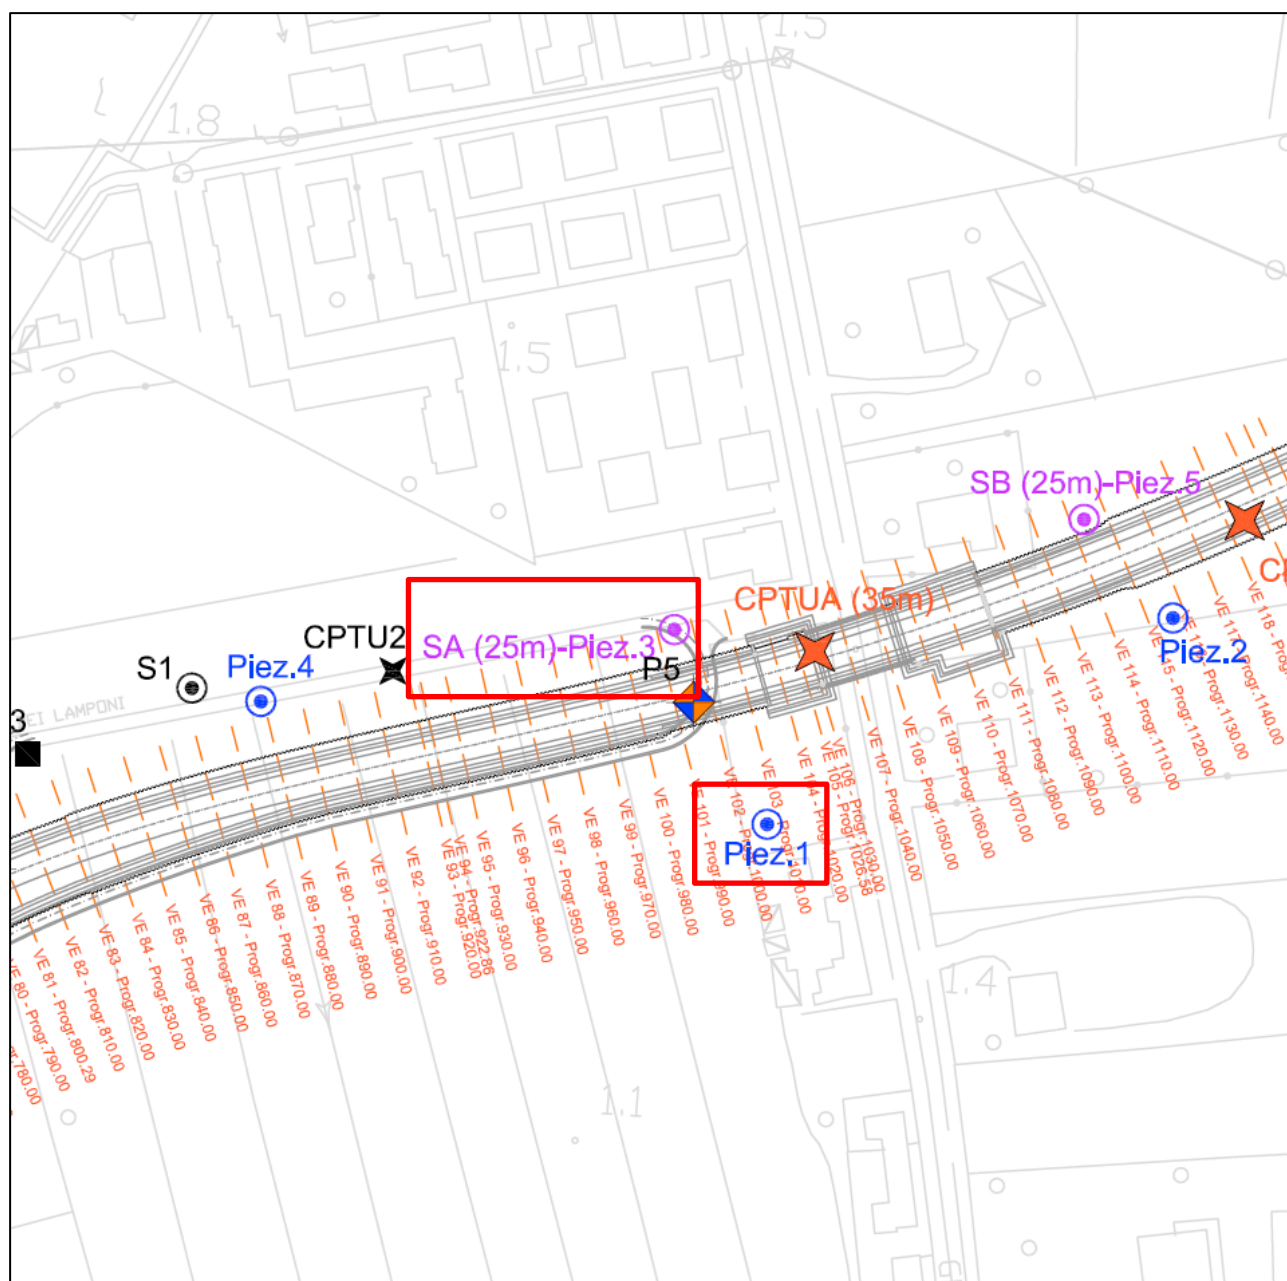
Ubicazione dei piezometri monitorati da planimetria di progetto
